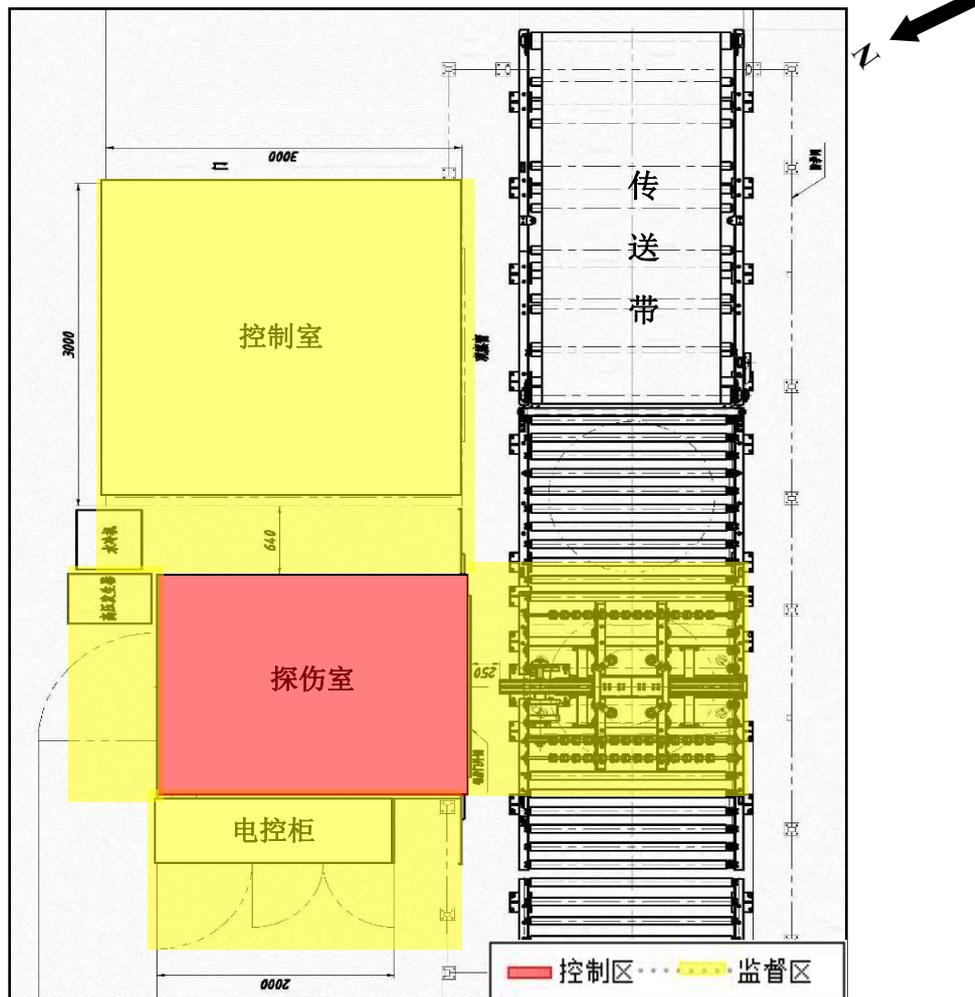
YLX-ZL1527 型轮胎 X 射线检验机工作场所平面布置图
